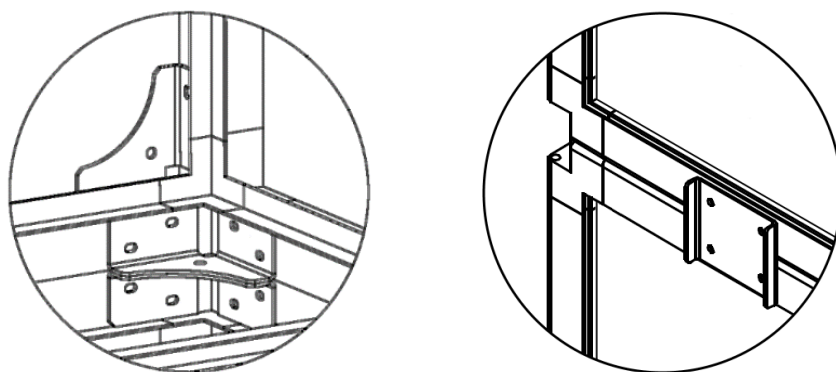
Соединение этажей изнутри (угловые) и снаружи
